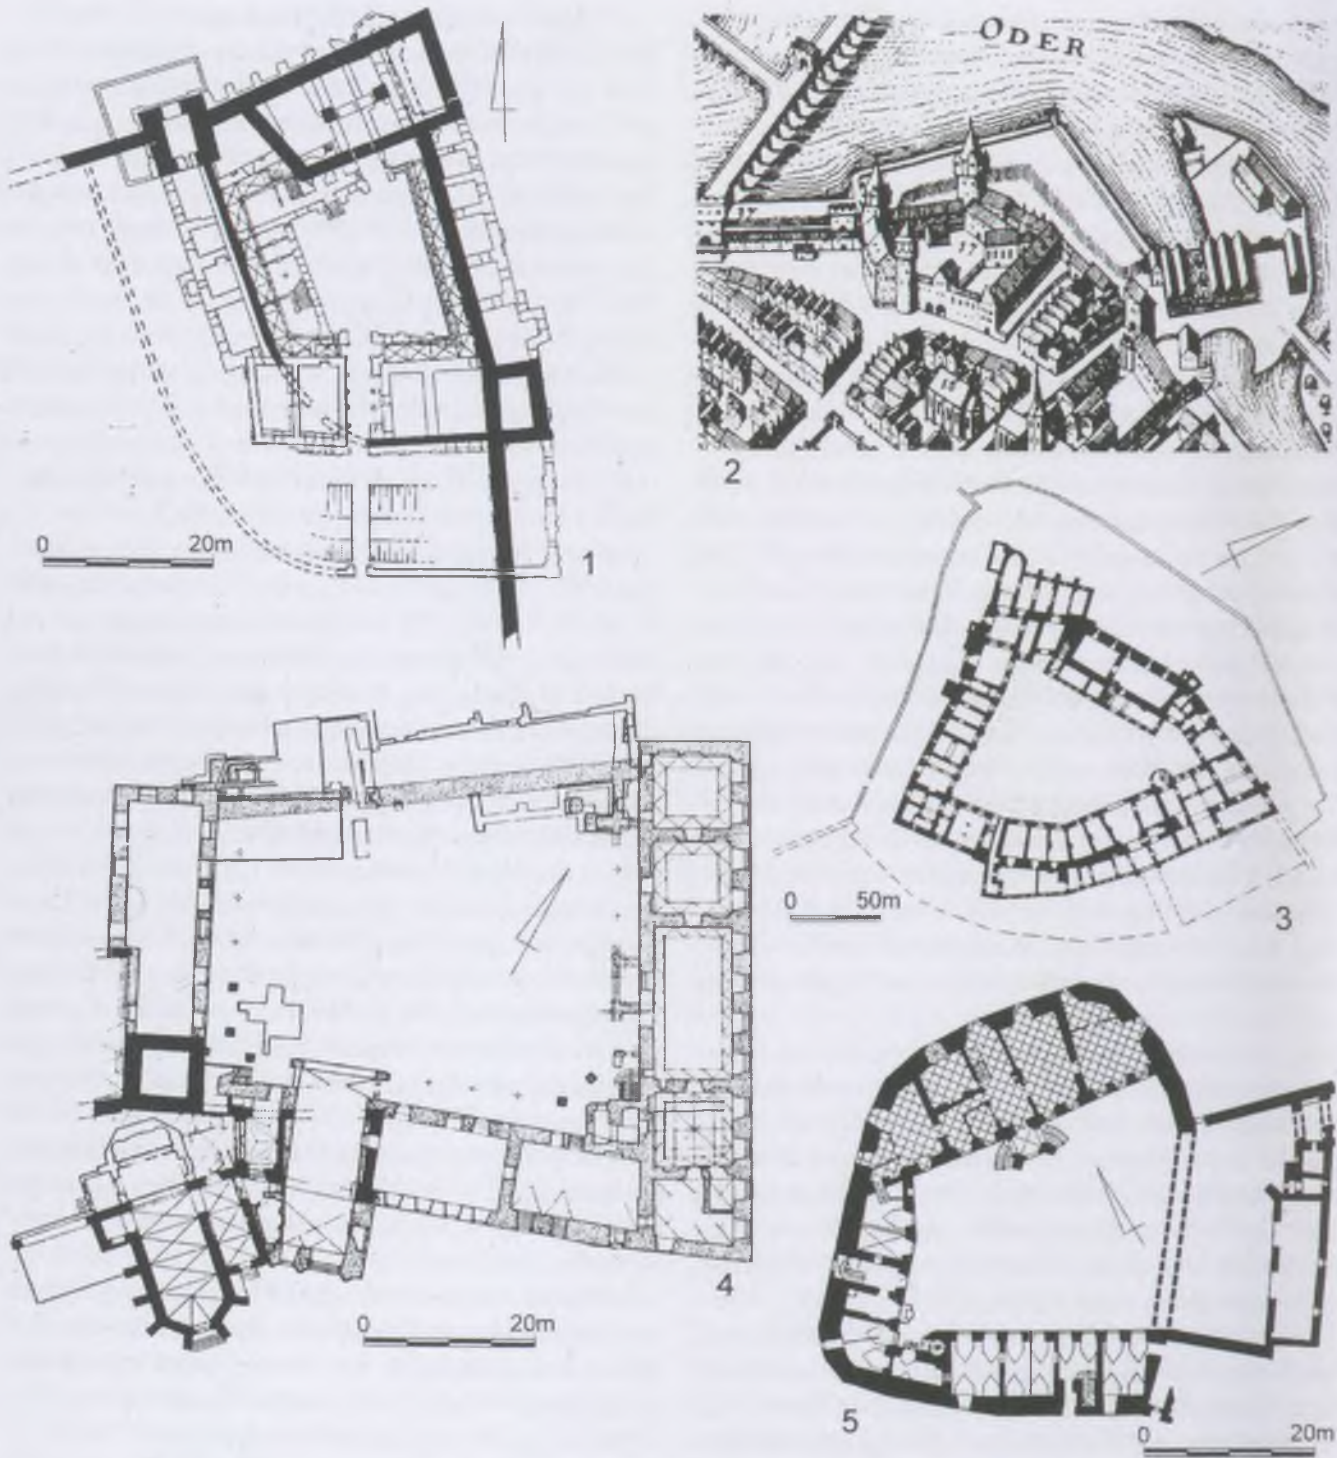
1 Bielitz (Bielsko). Grundriss der Burg. Schwarz: Mauerwerk des 14. Jahrhunderts (nach Bicz-Suknarowski); 2 Breslau, Stadtburg. (Wrocław, zamek lewobrzeżny). Aus dem Stadtplan von Merian von 1650; 3 Jauer (Jawor). Grundriss der Burg (nach Pilch); 4 Brieg (Brzeg). Grundriss der Burg. Schwarz: Mauerwerk des 14. Jahrhunderts (nach Rozpędowski); 5 Namslau (Namysłów). Grundriss der Burg. Schraffiert: Palas aus dem 14. Jahrhundert (nach Chorowska).
